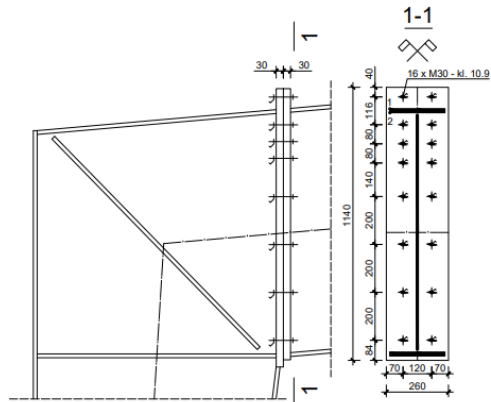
Rodzaje i lokalizacja połączeń montażowych
